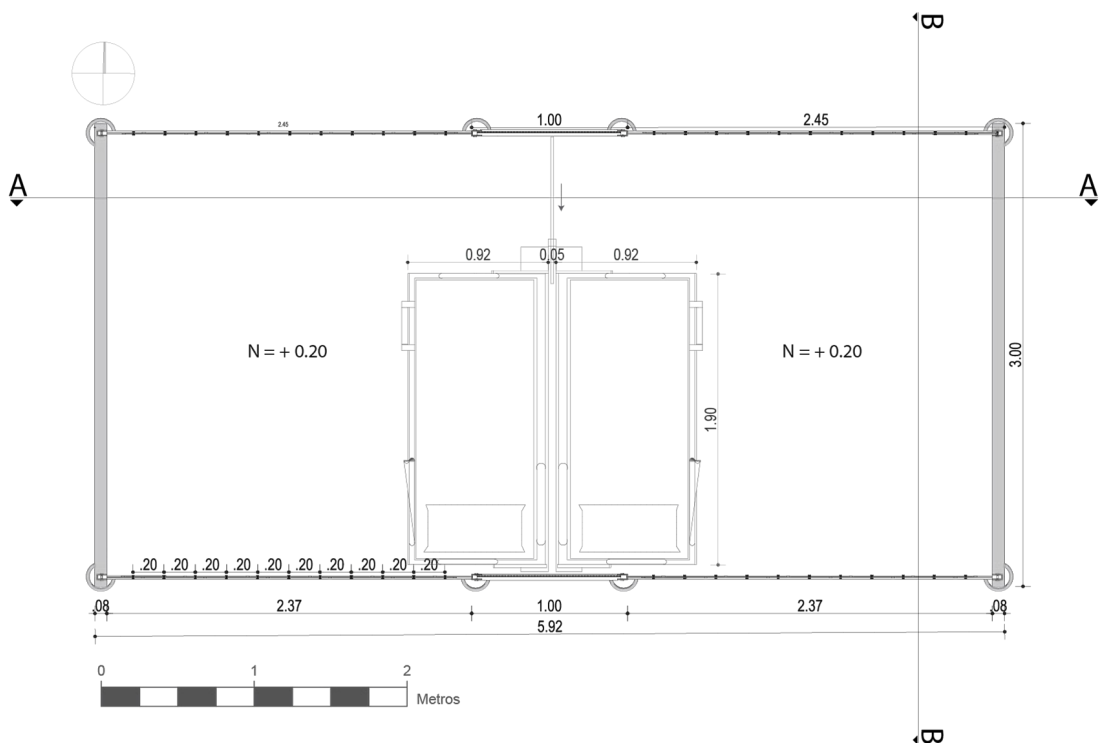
Folding Shelter Housing Zona de descanso. Elaboración: Autores
